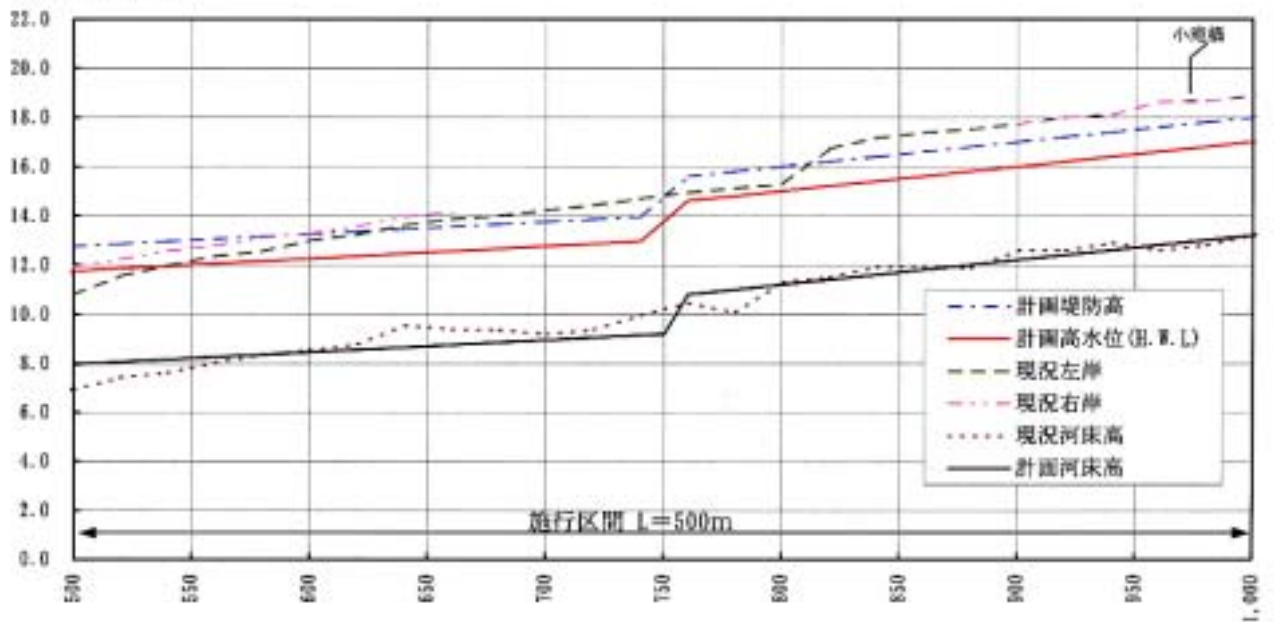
(4) 黒瀬川縦断面図 (町田地区)
